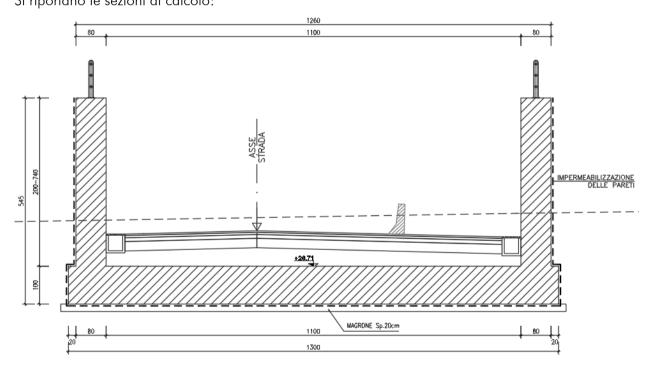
Sezione di calcolo muri di imbocco SL20
